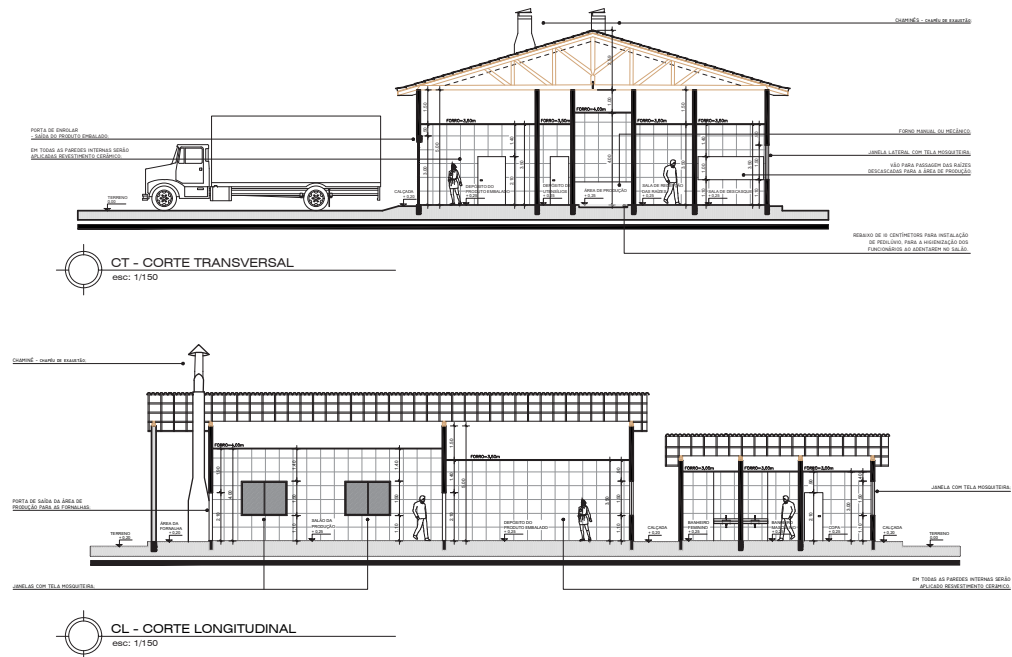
Corte transversal e corte longitudinal de uma casa de farinha conforme a legislação vigente
